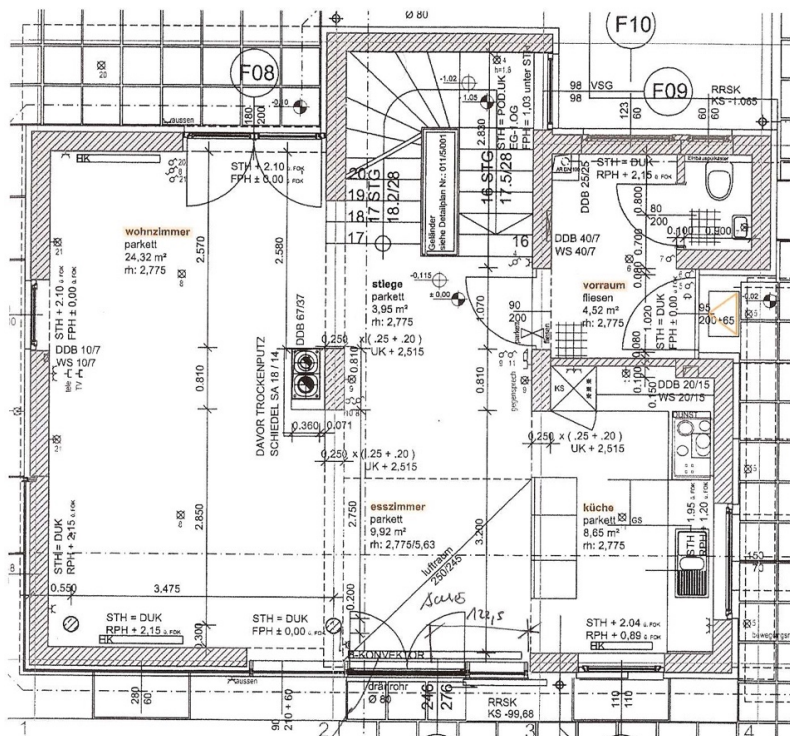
Bestandsplan, Grundriss, Atelier Körner
